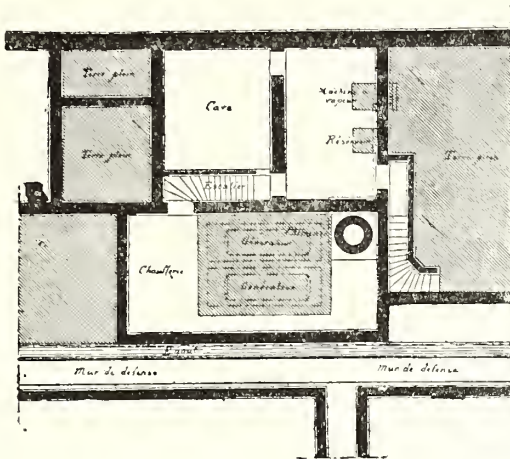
Plan du sous-sol. Échelle de 0,0025 par mètre.
